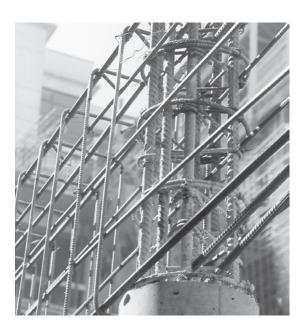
Estribos individuales de viga y pilar. (Gentileza de Eduardo Effa).
